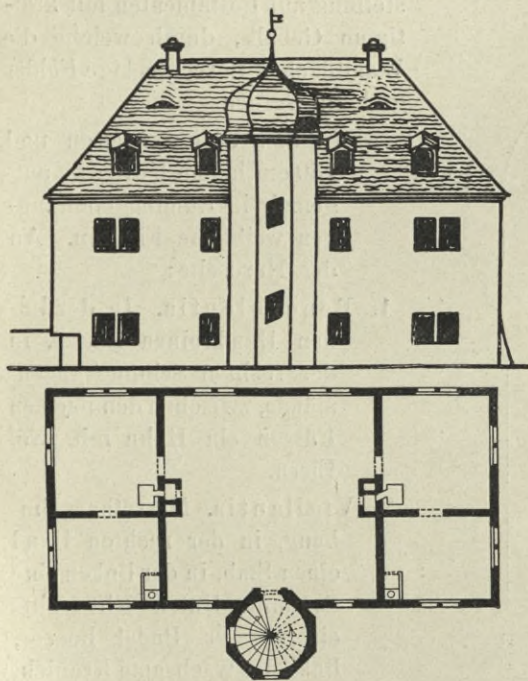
u. 149. Hoflössnitz, Wohnhaus, Ansicht und Grundriss des ersten Obergeschosses.
